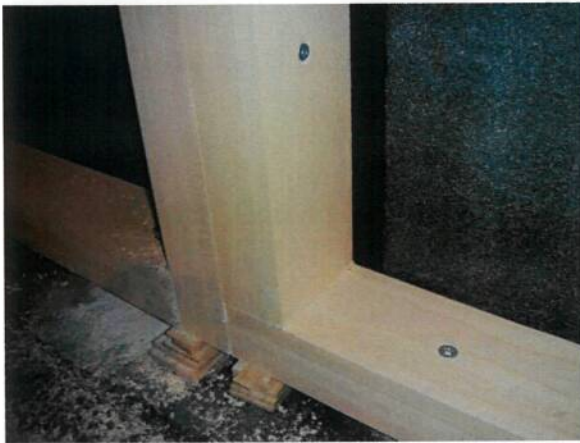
Fügen der Holzrahmen; Winkeleisen mit SFS Doppelgewindeschrauben WT-T 4,5x60
